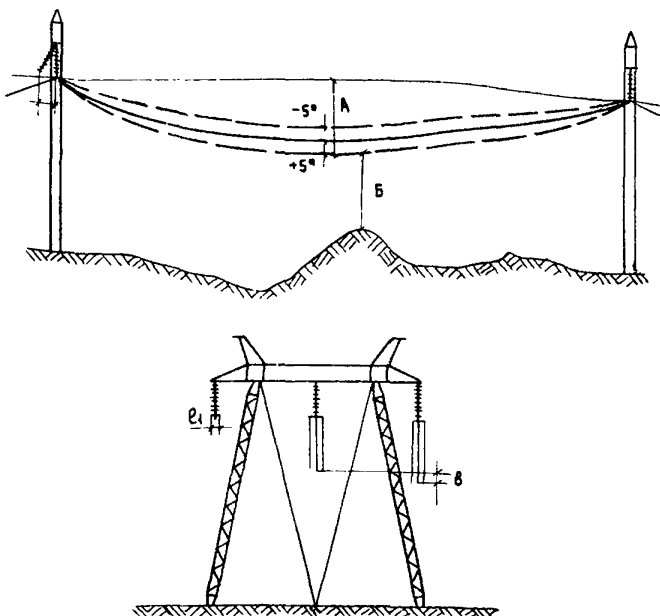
Нормы и допуски на монтаж проводов
